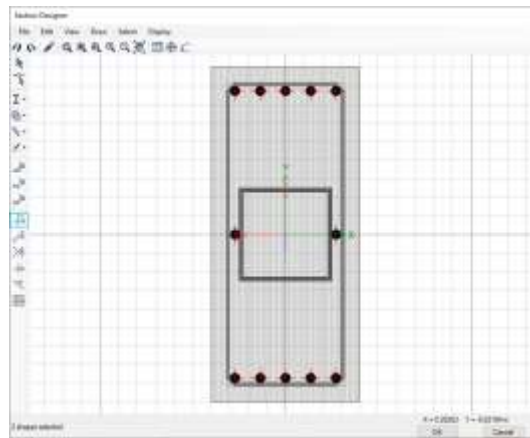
Definición de columna de 40x90 reforzada con perfil metálico tubular cuadrado
